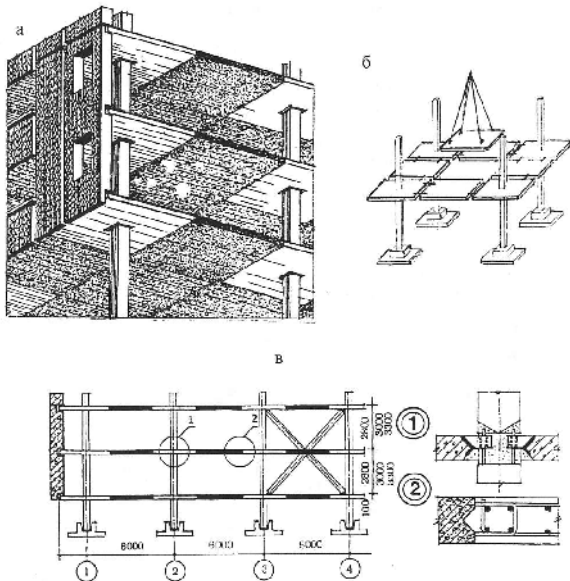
Система безригельного каркаса (КУБ): а - общий вид; б - схема последовательности монтажа; в - схема разреза здания
